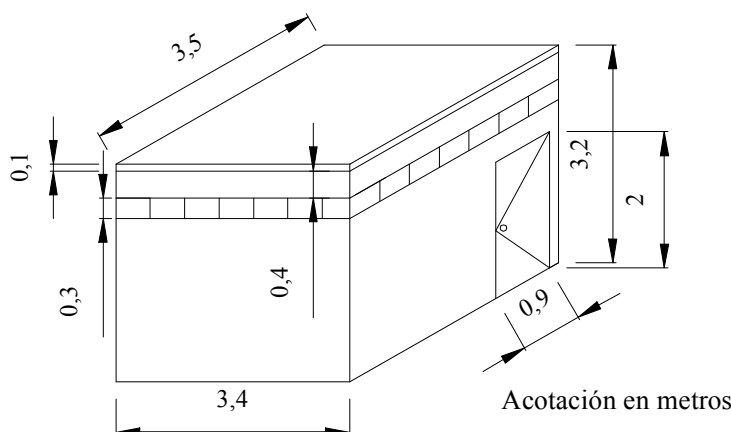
DIMENSIONES DEL CUARTO DE MAQUINAS.
